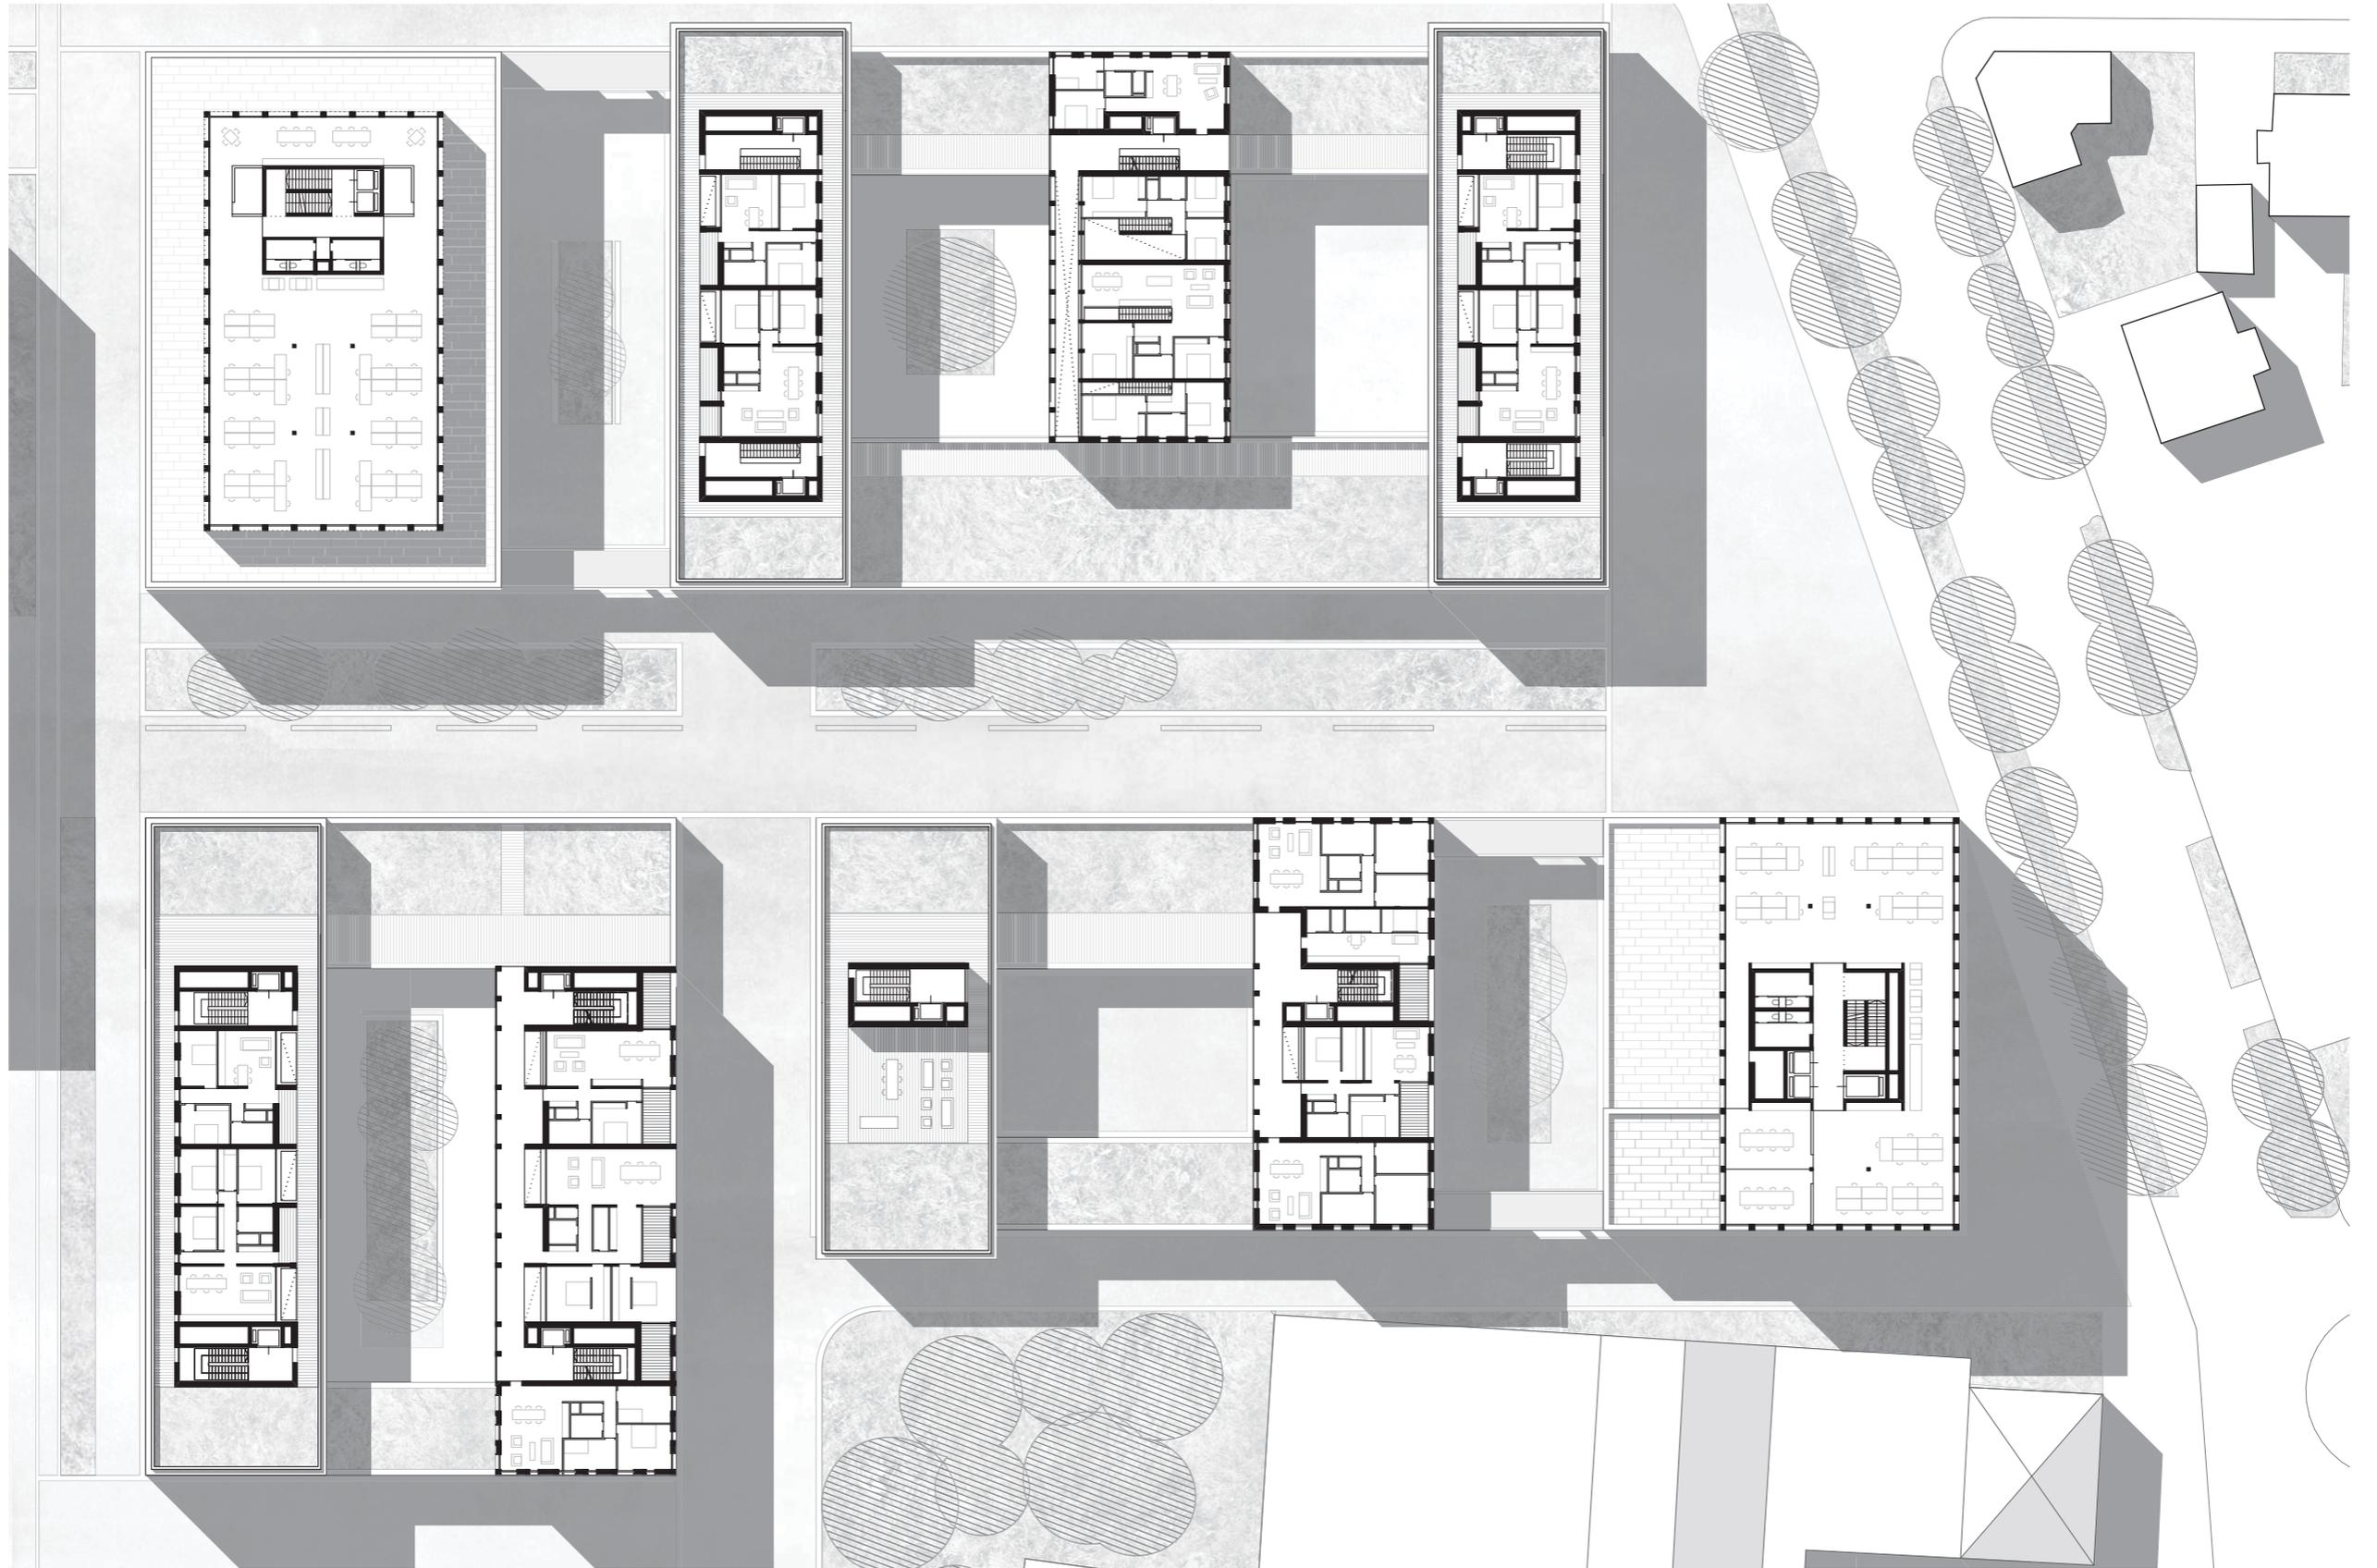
Grundriss 4. Obergeschoss, Ausschnitt Ost
